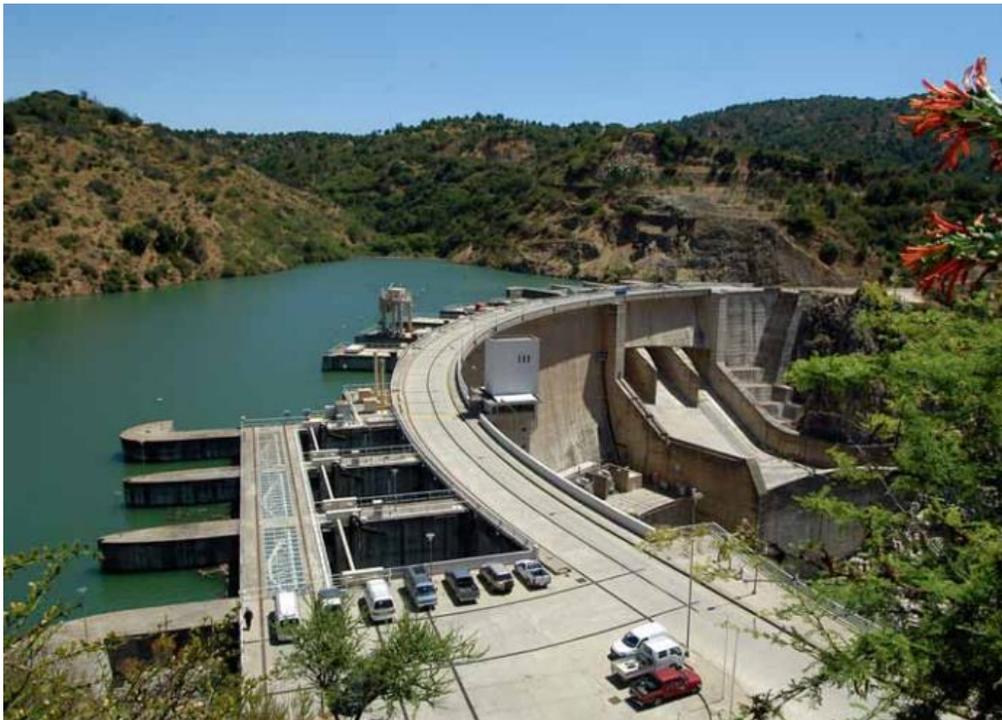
Muro del Embalse Rapel en la Actualidad
